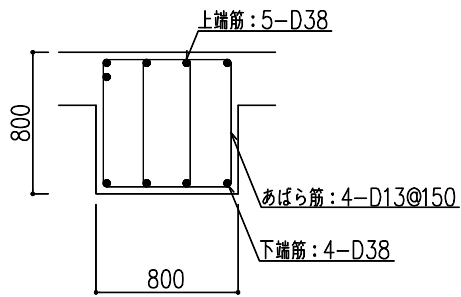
大ばりの配筋図 (2階, X8a 通り YM~YN 通り間, 端部) (単位: mm)
